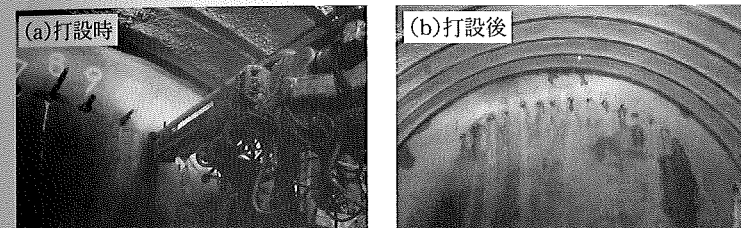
長尺鏡ボルト施工状況(六戸トンネル)
